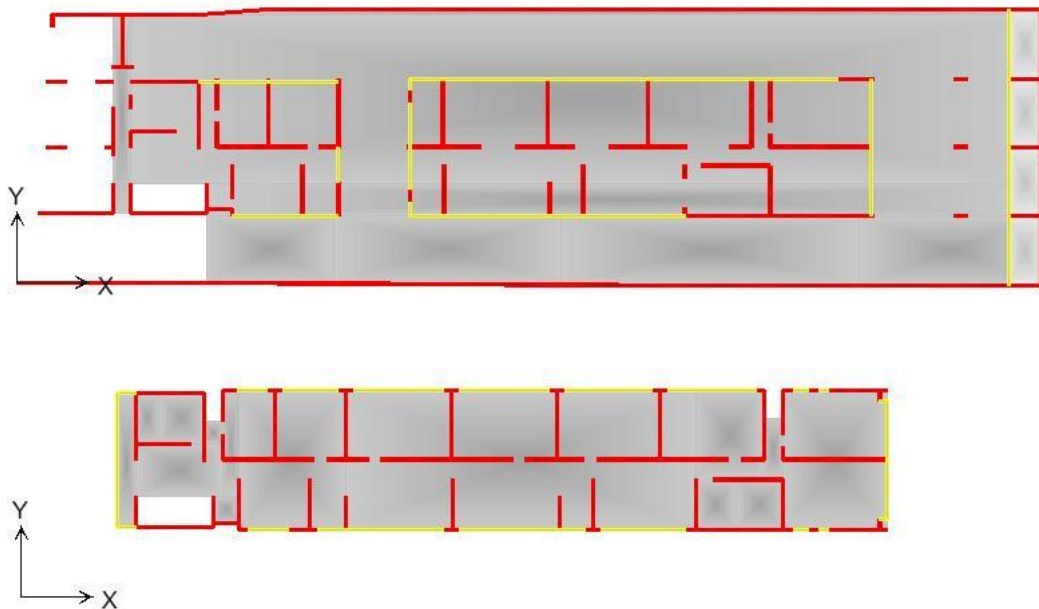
Planta primer piso (arriba) y piso tipo (abajo) edificio H13
